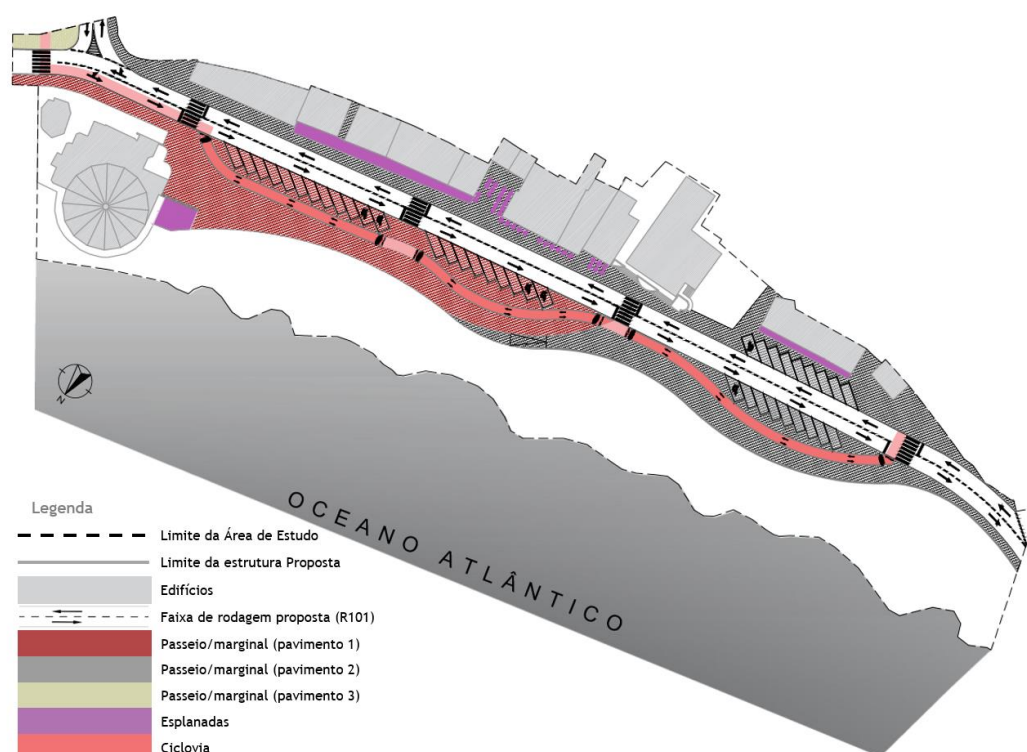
Planta esquemática: Zona do Calhau. Ciclovia. [s/escala]
